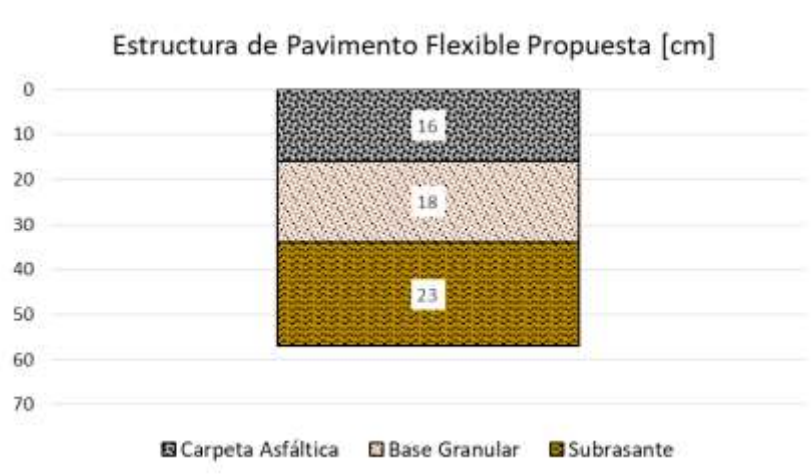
Estructura de Pavimento Flexible Propuesta
